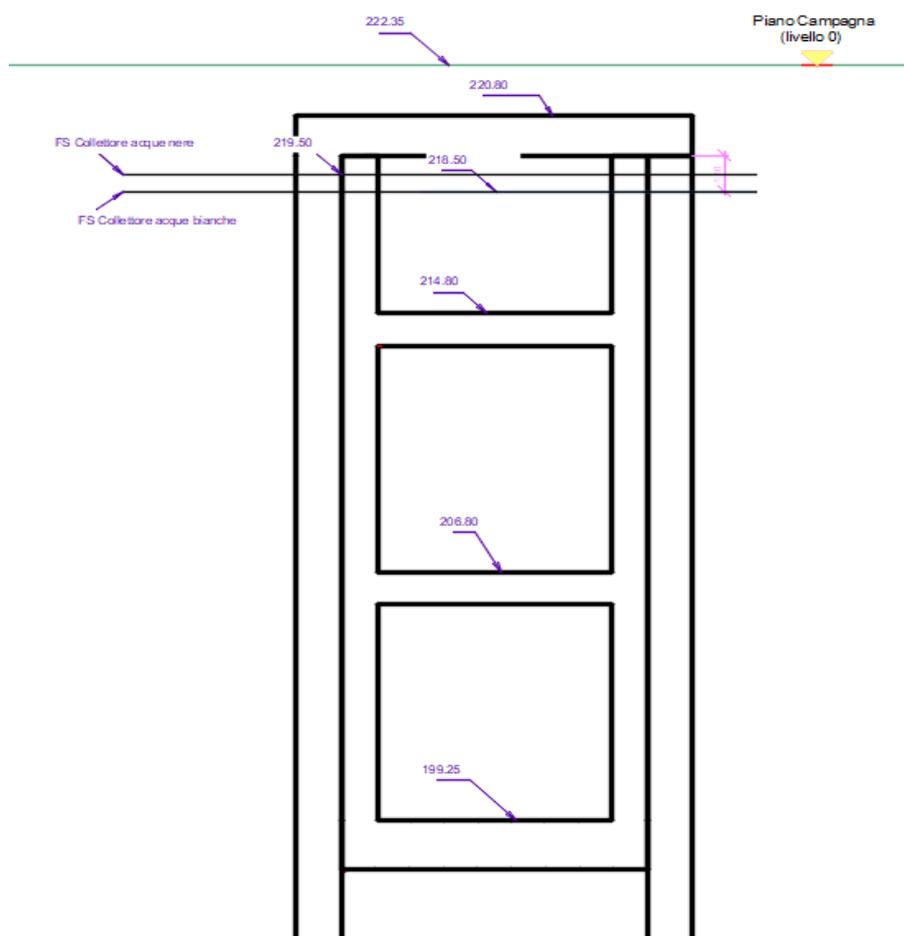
Sezione trasversale della Galleria artificiale (GA5) in via Cimarosa e quota di attraversamento del collettore delle acque nere
